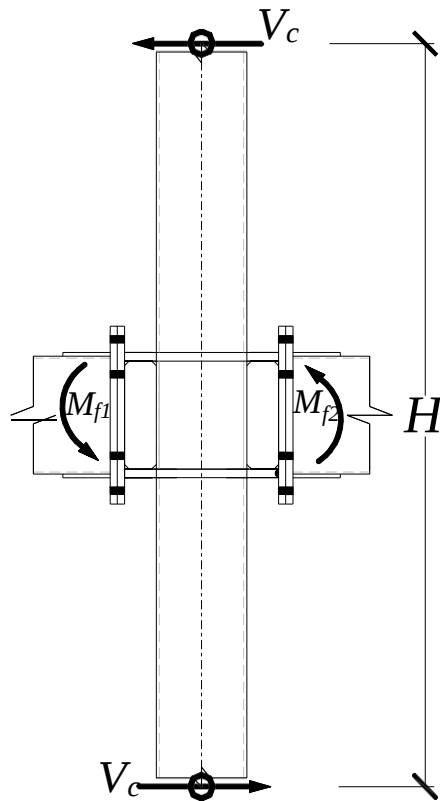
Esquema para el cálculo del corte producido por las vigas del pórtico
